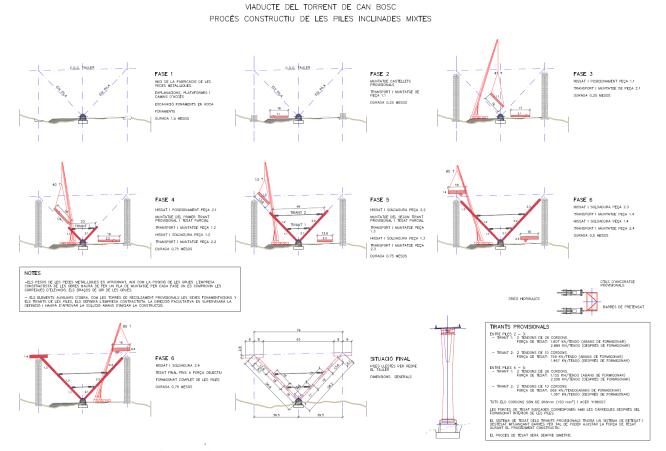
Plano del proceso constructivo de las pilas inclinadas.
